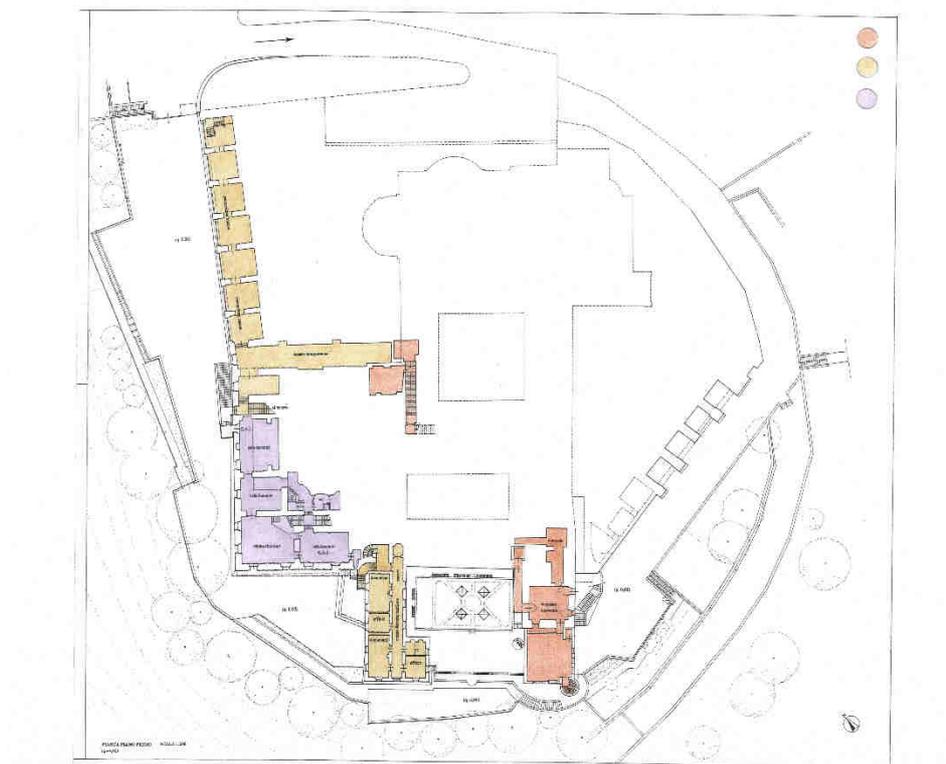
Pianta piano seminterrato; in giallo, nella zona sud, la biblioteca CAI, in rosso la biblioteca conventuale
